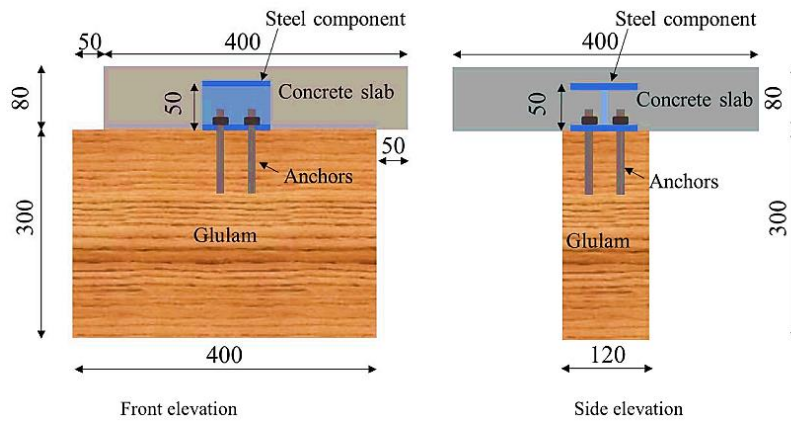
Schéma et géométrie des éprouvettes de Push-out Asymétrique (dimensions en mm) établis par Ling 2022 [36]
